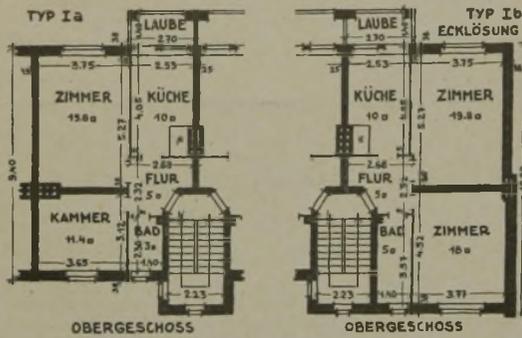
u. 26 (ganz links). Grundrisse einer Einzimmerwohnung m. Kammer und einer Zweizimmerwohnung in der Fritz-Reuter- und Parchimer Allee.
